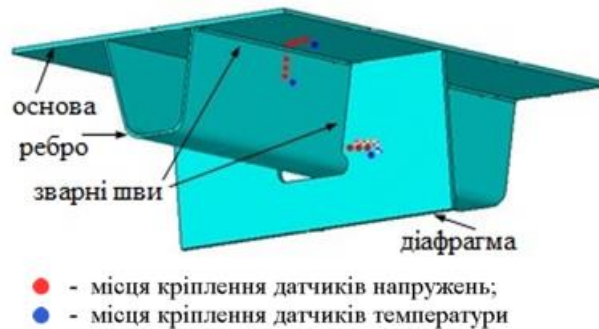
Схема розміщення датчиків FBG для вимірювання напружень на складній металевій конструкції
